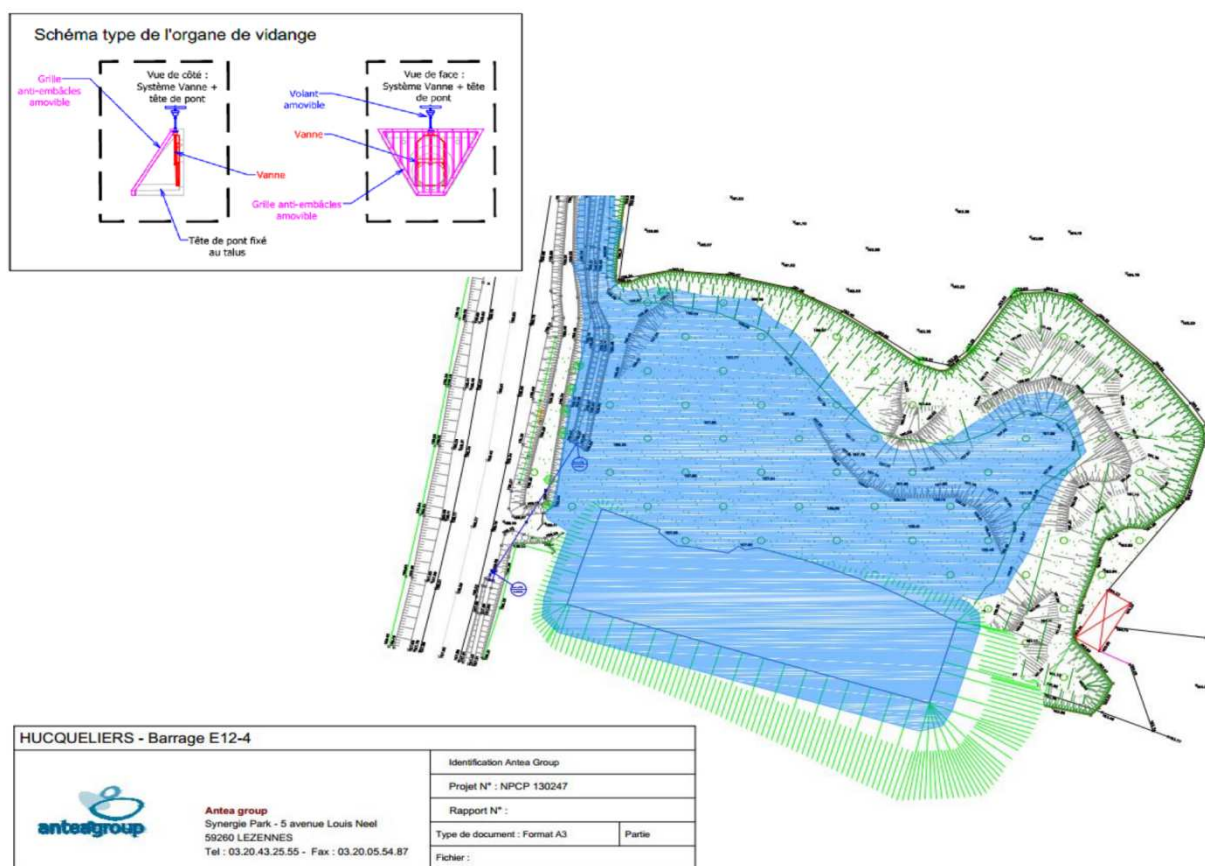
Extrait du plan de masse – Ouvrage E12-4
